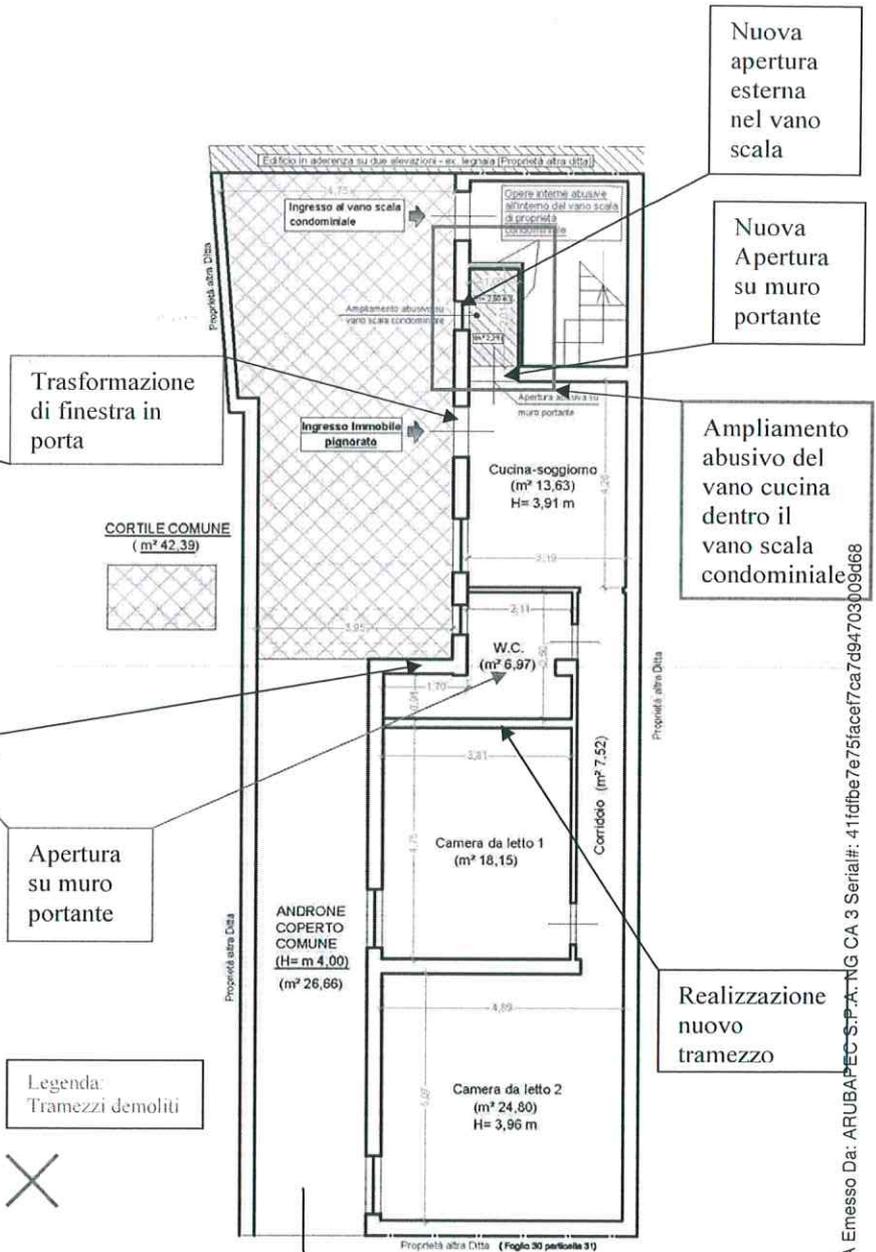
Stralcio planimetria di rilievo immobile pignorato
